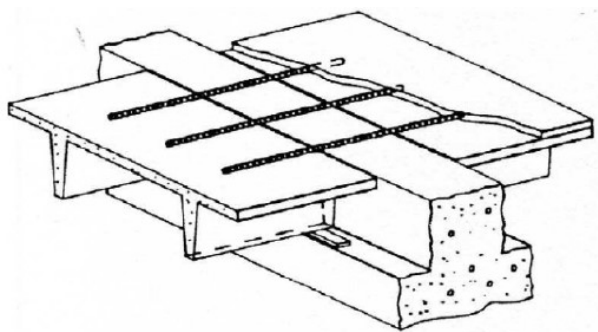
Ligação de lajes duplo “T” em vigas “T” invertida, através de armadura ordinária em lajes, sobre neoprene, em paralelo com a laje (PCI,2004)
